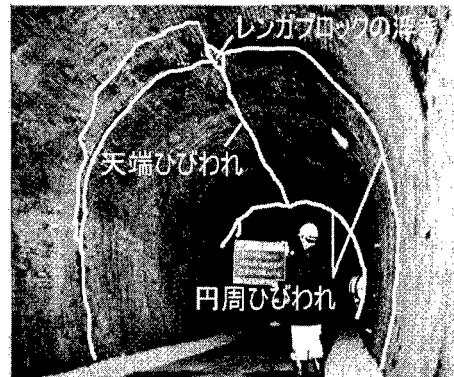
円周ひびわれと天端ひびわれの閉合（2号トンネル）
